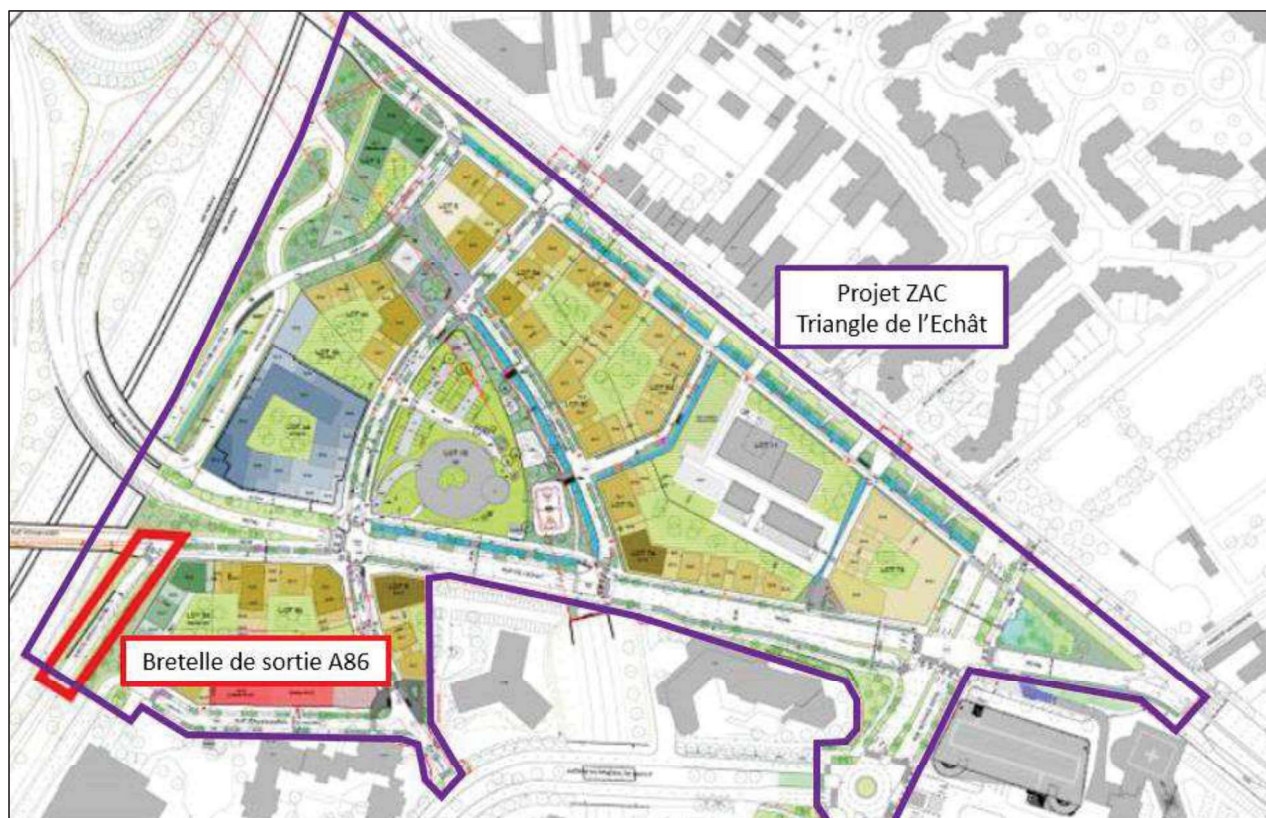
Plan de masse indicatif du réaménagement de la ZAC [1]
